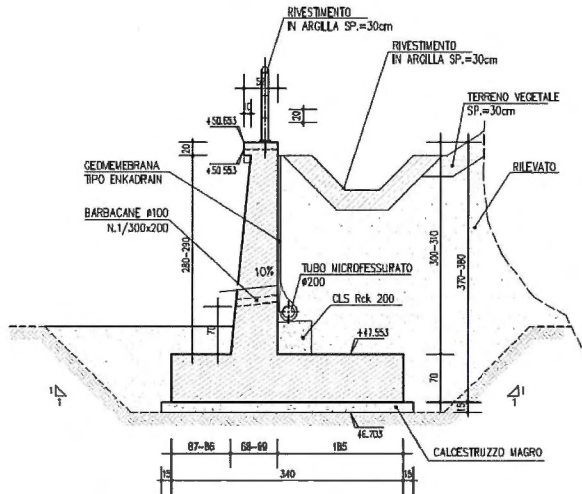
Sezione Tipo - Muro 3 Concio 5
